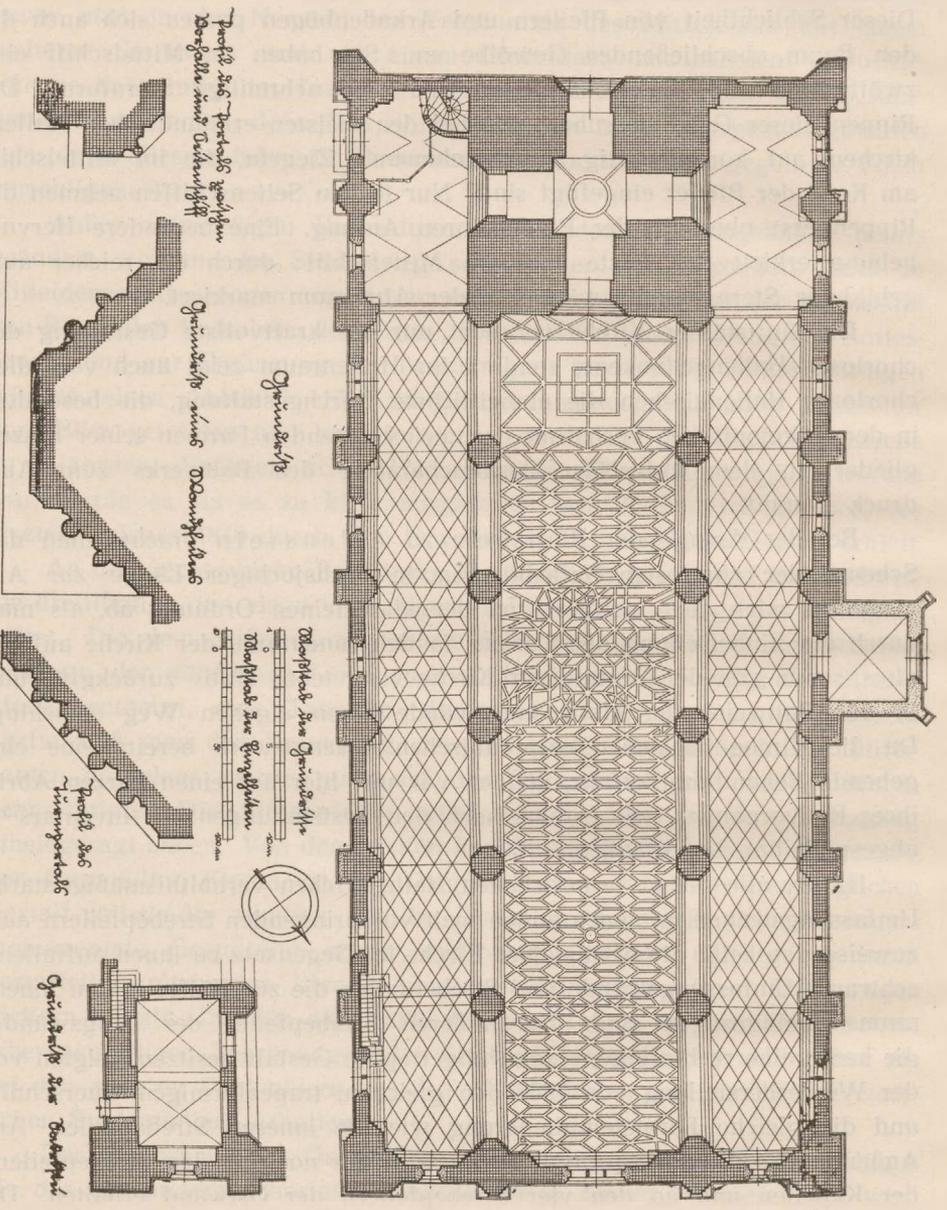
Pfarrkirche zu Allenstein, Grundriß.
